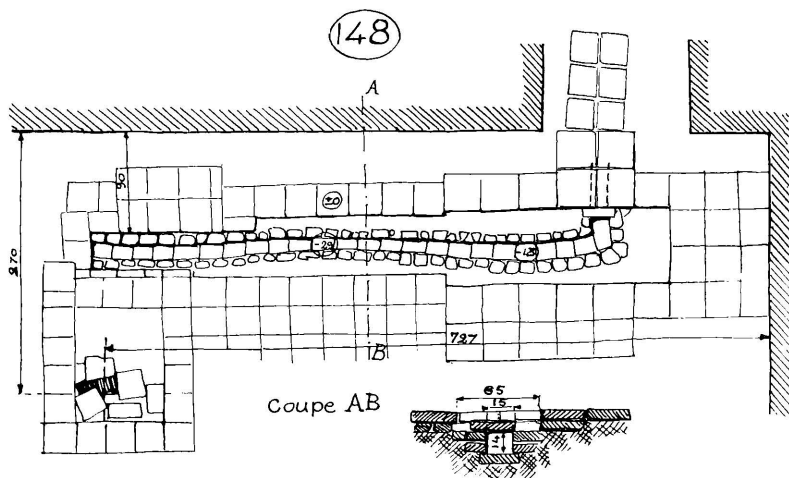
Cour 148. Détail (plan et coupe) de la canalisation.
